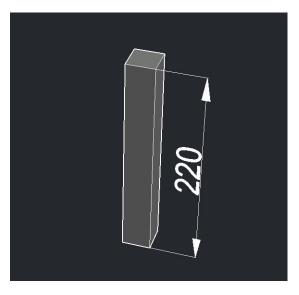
Dimensiones en propuesta de pilares para proyecto estandarizado. Fuente: Elaboración propia.
